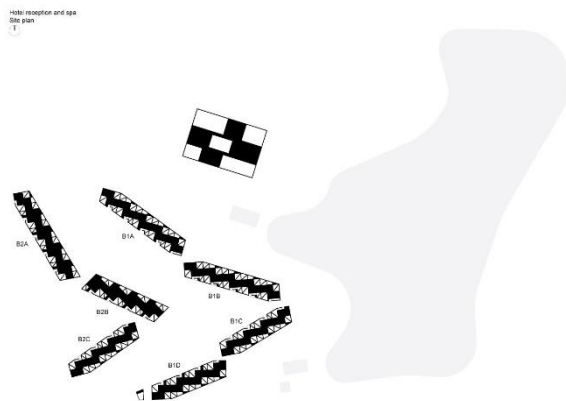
Vineyards Luxury Wine Resort, Planta de implantação
